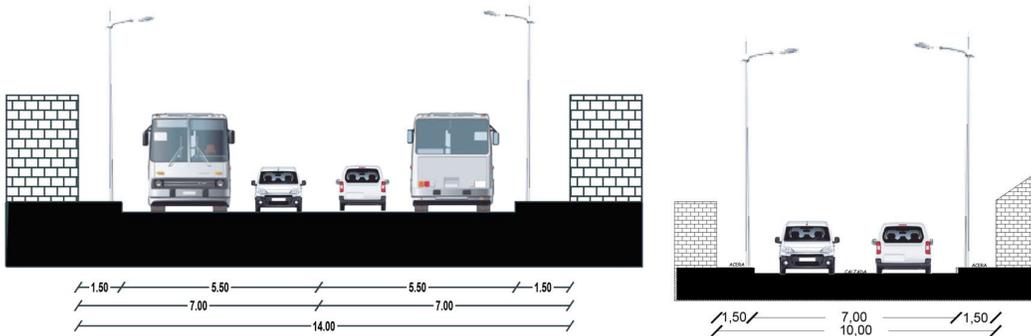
Corte Vial – Calles Ñusta – Calle Oe1N
